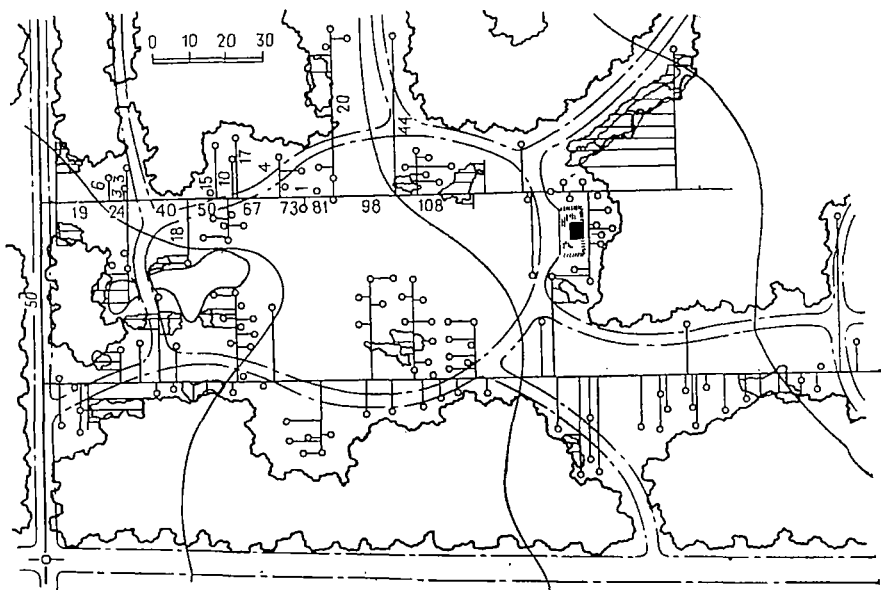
Схема разбивочного чертежа с абсиссными и ординатными осями
